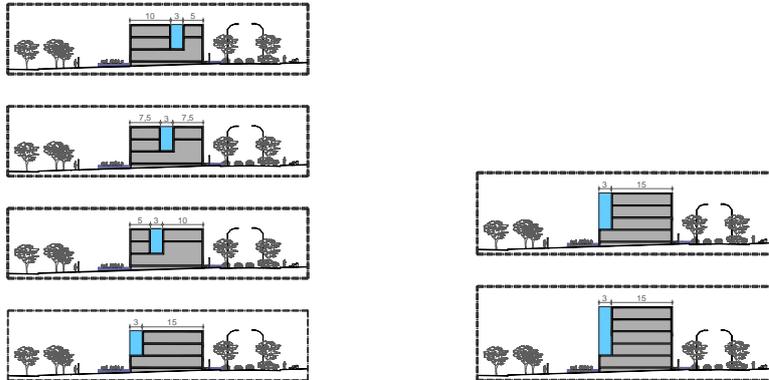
Plano de detalhe H3A – Secções definindo as volumetrias tipo.
